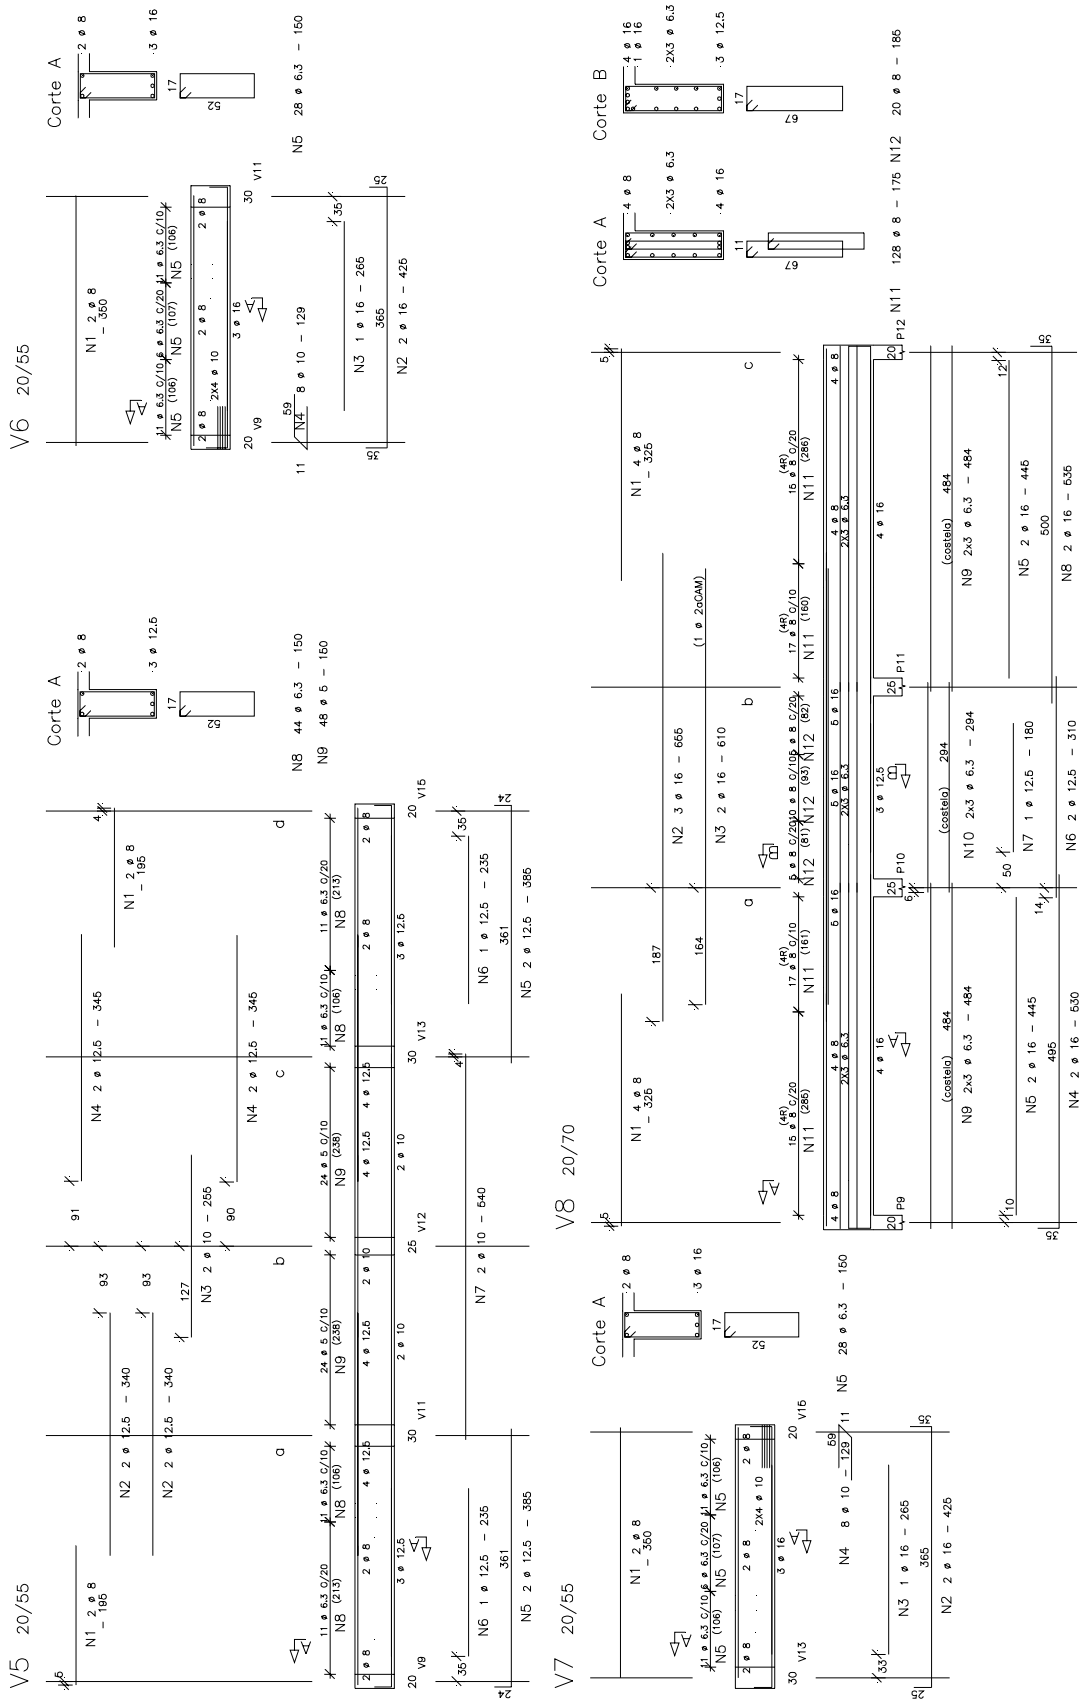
Prédio “C” – Opção 3 – Armadura das vigas V5, V6, V7 e V8
